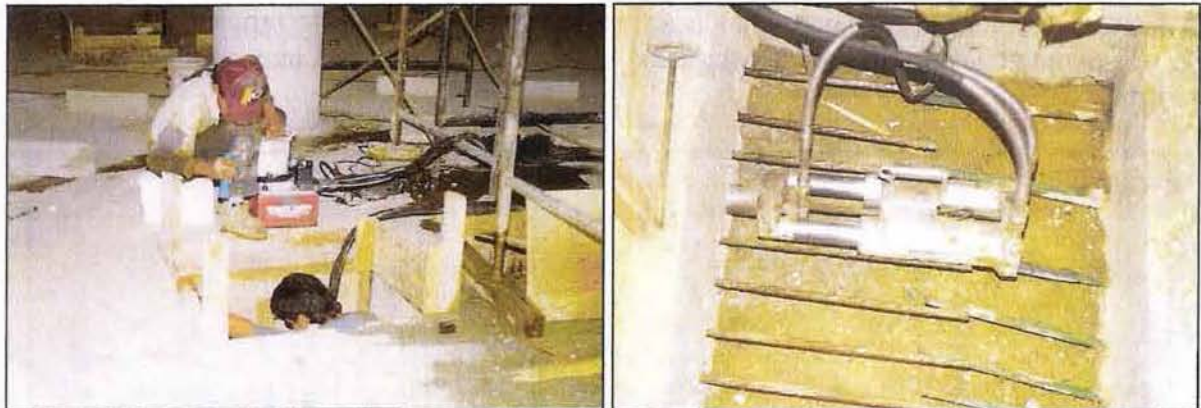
Tensado de los torones traslapados de el tendón de preesfuerzo de las contratraves de cimentación, cerca al eje B del edificio. En el lado izquierdo se aprecian los marcos de reapuntalamiento de las traves y losas de primer piso.
